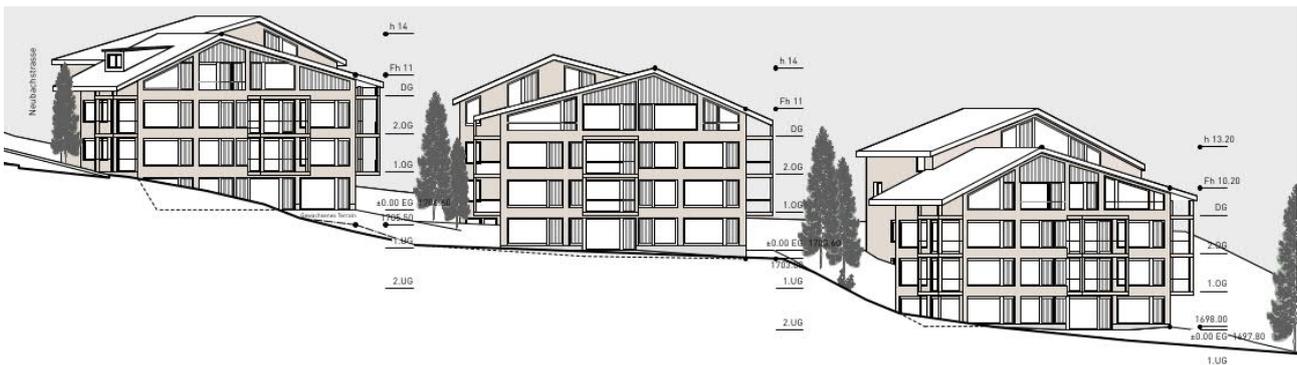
Ansicht Südwest ZAI (massstabslos)
